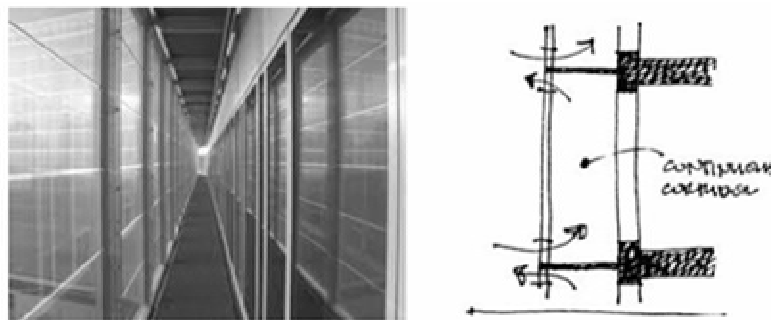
Section typique de la façade du couloir. (Faggal, 2014).
